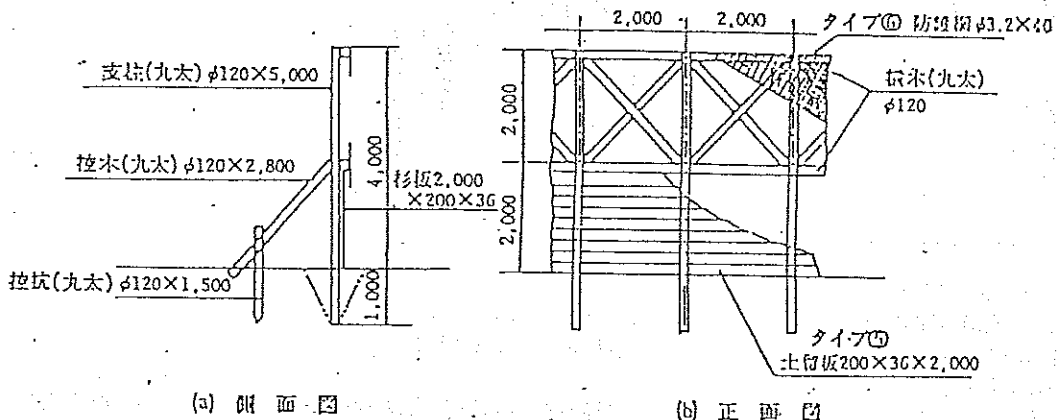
仮設防護柵標準タイプの例 (タイプ③, ④) (単位: mm)
